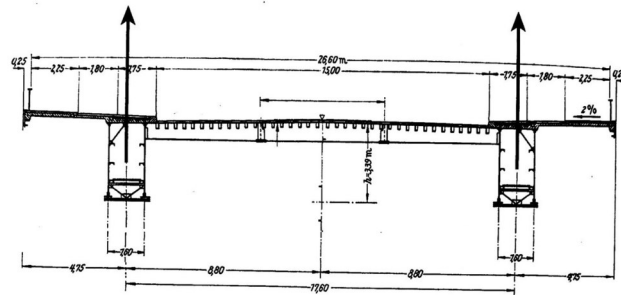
Betonová komorová mostovka s dvěma rovinami závěsů, Posadas-Encarnación Bridge [1]
